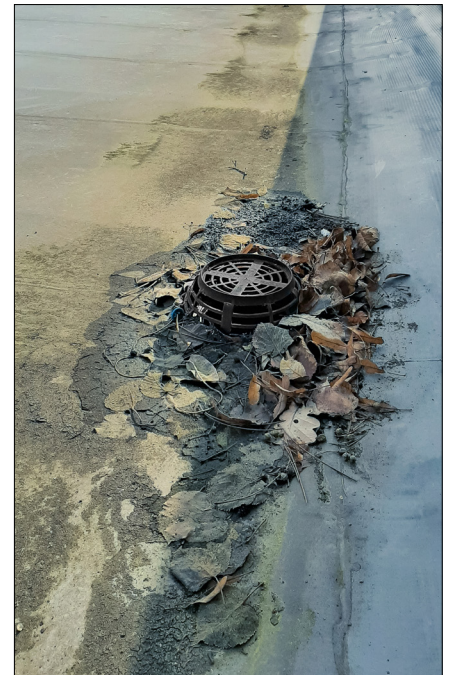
Kein seltener Anblick für Dachdecker: Ein durch Laub zugesetzter Dachgully.
